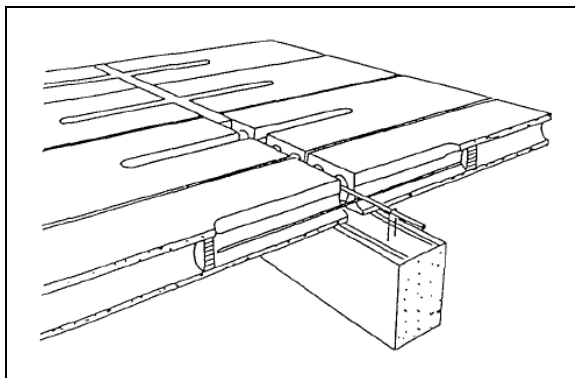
Ligação de lajes alveolares através de amarração, em paralelo com a laje (Elliott, 1996)
